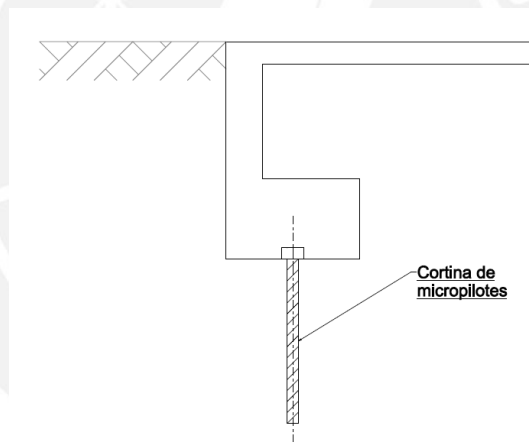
Cortina de micropilotes debajo de estribo de puente (Fuente propia, 2015)
